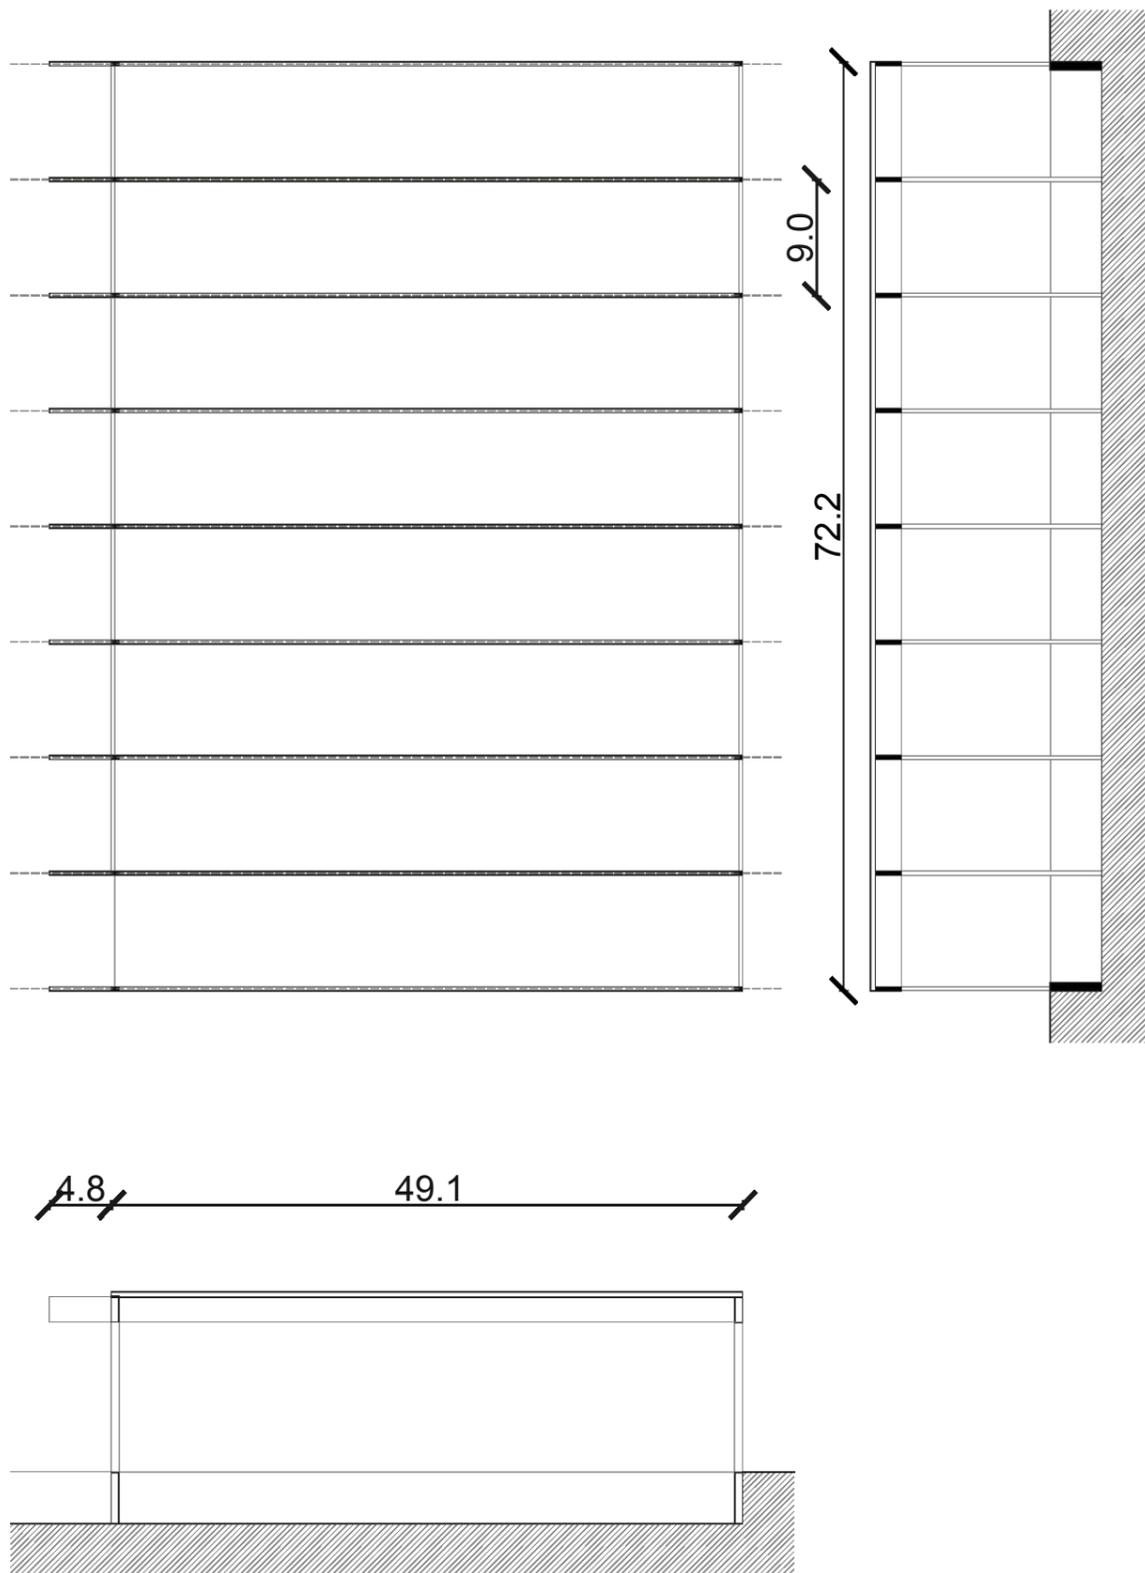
Konstruktionsprinzip - Schwimmhalle
